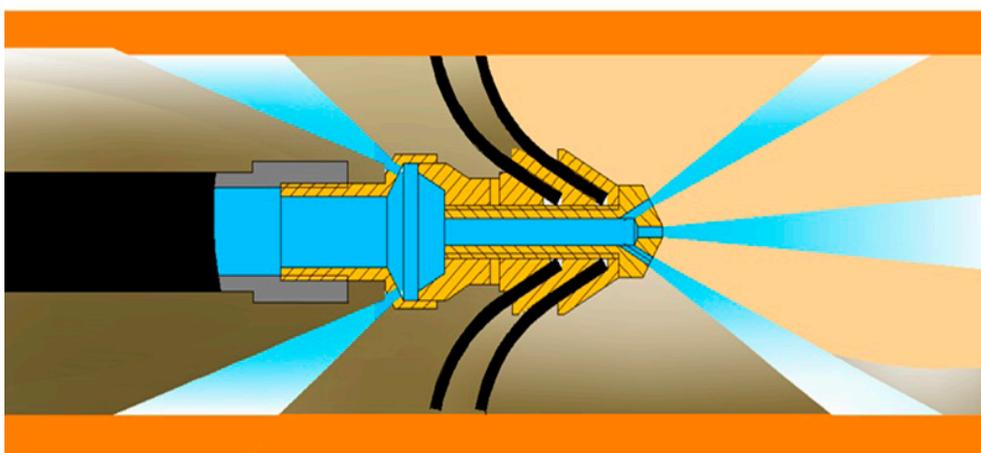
Извлечение насадки промывочной из дренажного трубопровода
